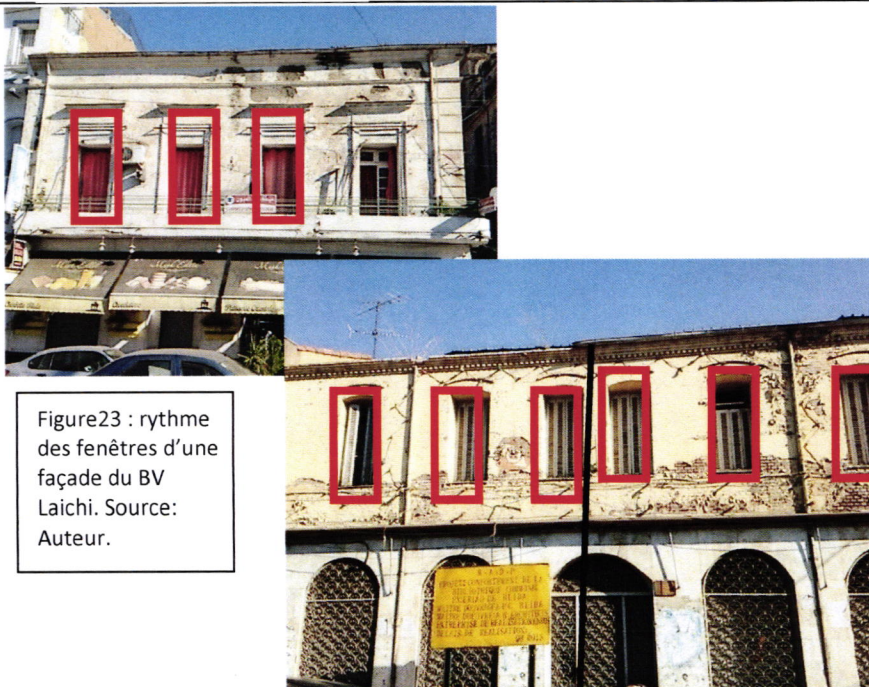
rythme des fenêtres d'une façade du BV Laichi. Source: Auteur.
